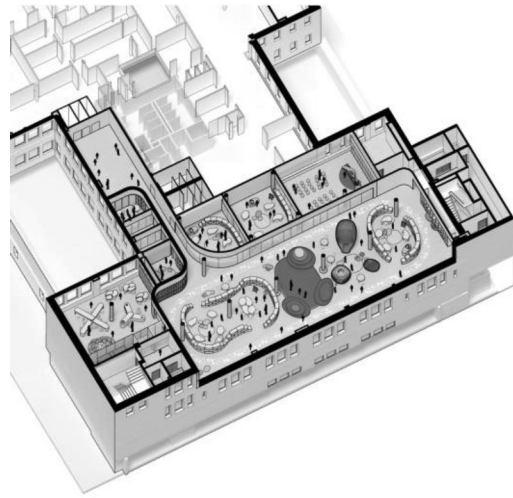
3D ilustrativo da planta da WeGrow (Fonte: Archdaily)
